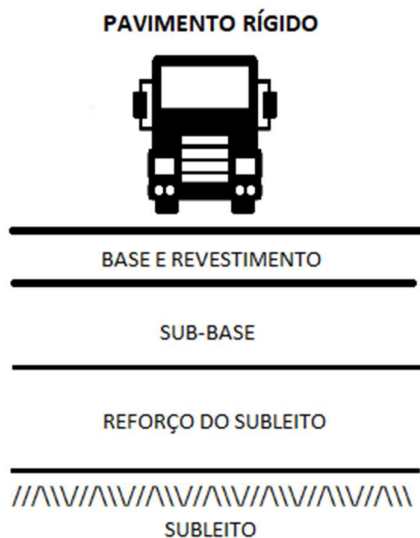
Constituição de um pavimento rígido (LNEC, 2005)
